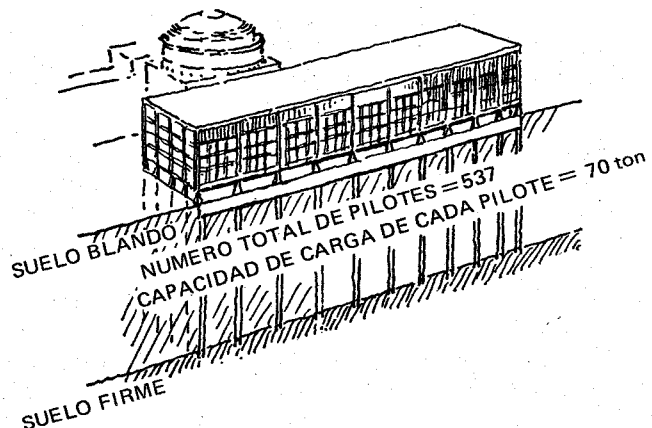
Edificio con cimentación profunda por pilotes.
